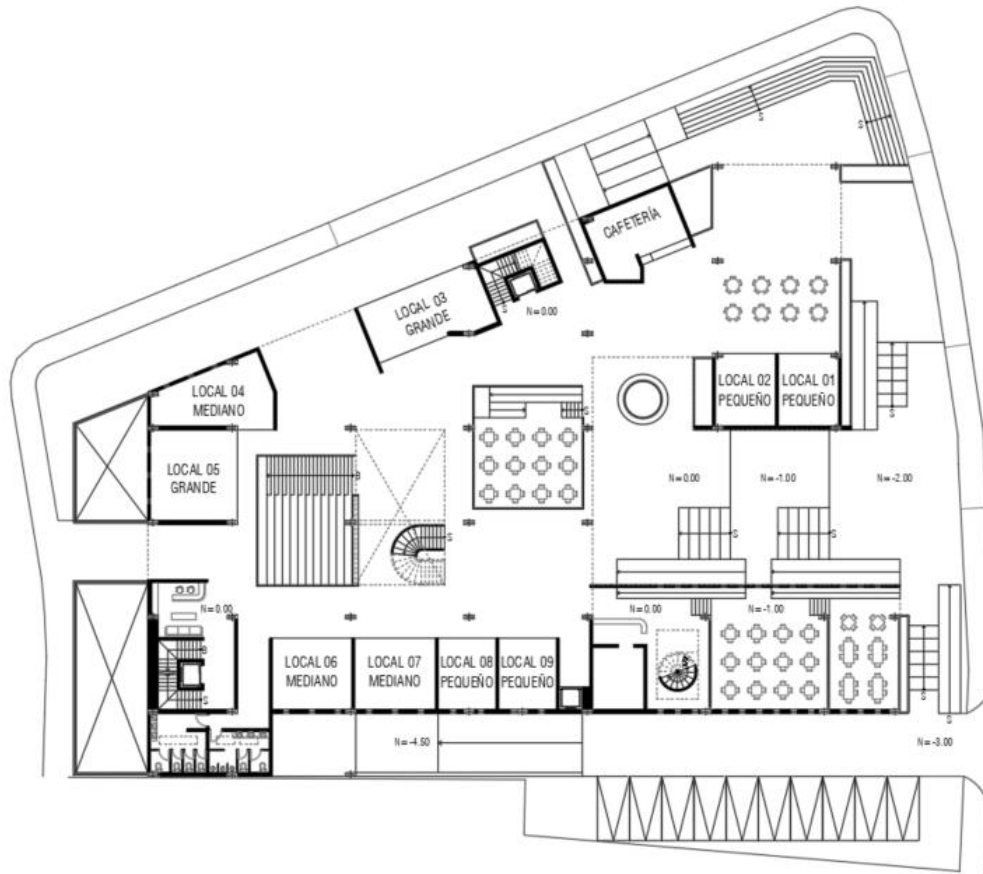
Planta baja - Anteproyecto 02. Elaboración propia.
